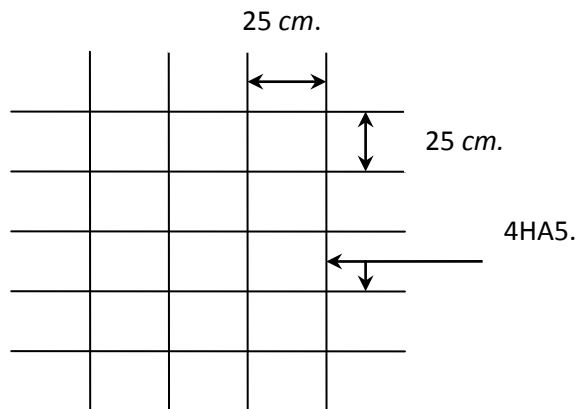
Fig III-A- Ferrailage de dalle de compression avec un treille soudée
